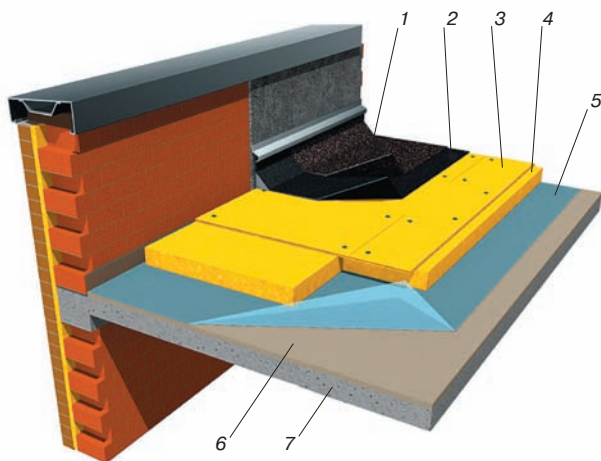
Конструкция покрытия с рулонной кровлей и тепловой изоляцией из плит ISOVER OL-TOP, ISOVER OL-P по несущему основанию из железобетона: 1 – защитный слой; 2 – гидроизоляционный ковер; 3 – верхний теплоизоляционный слой из плит ISOVER OL-TOP; 4 – нижний теплоизоляционный слой из плит ISOVER OL-P; 5 – пароизоляционный слой; 6 – выравнивающий слой; 7 – несущее основание из железобетона
